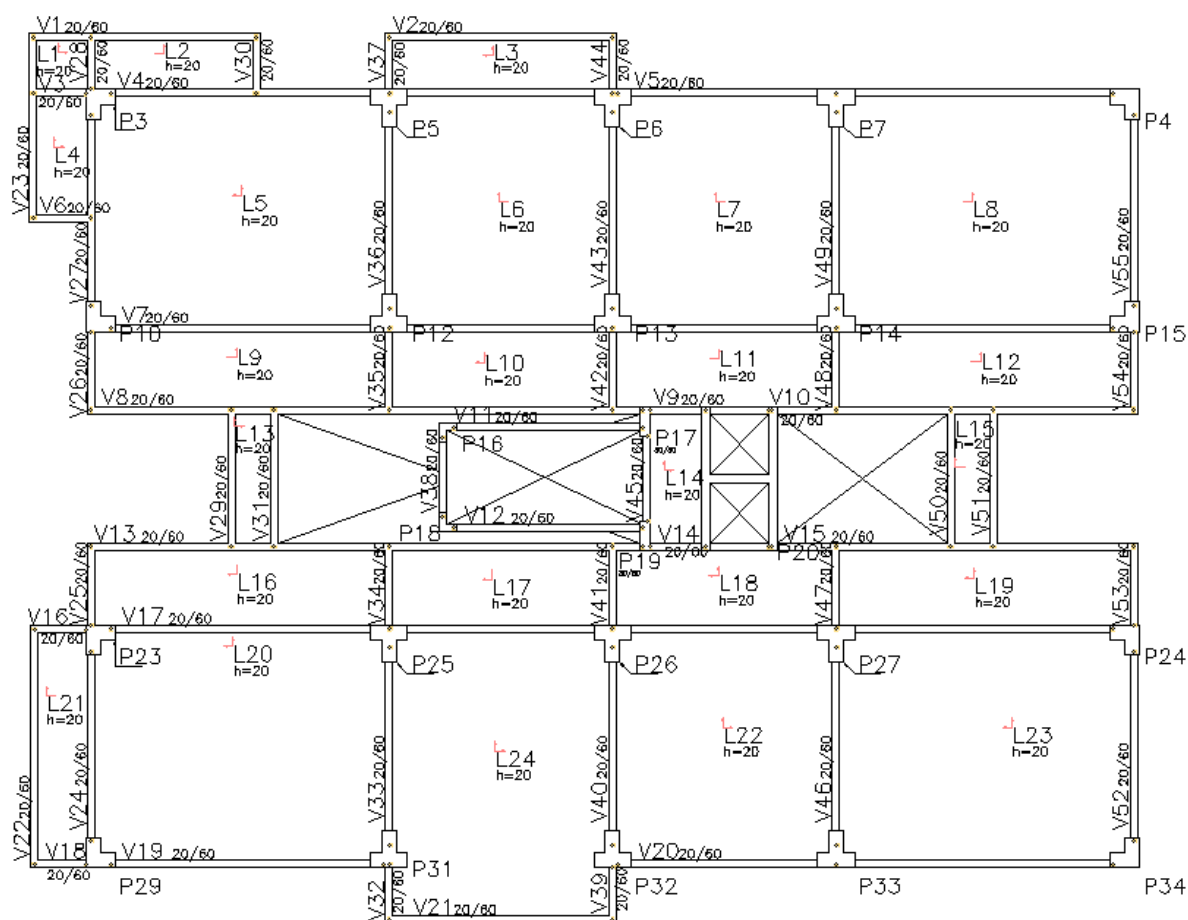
Desenho de fôrmas do pavimento PT5 da Solução Convencional
